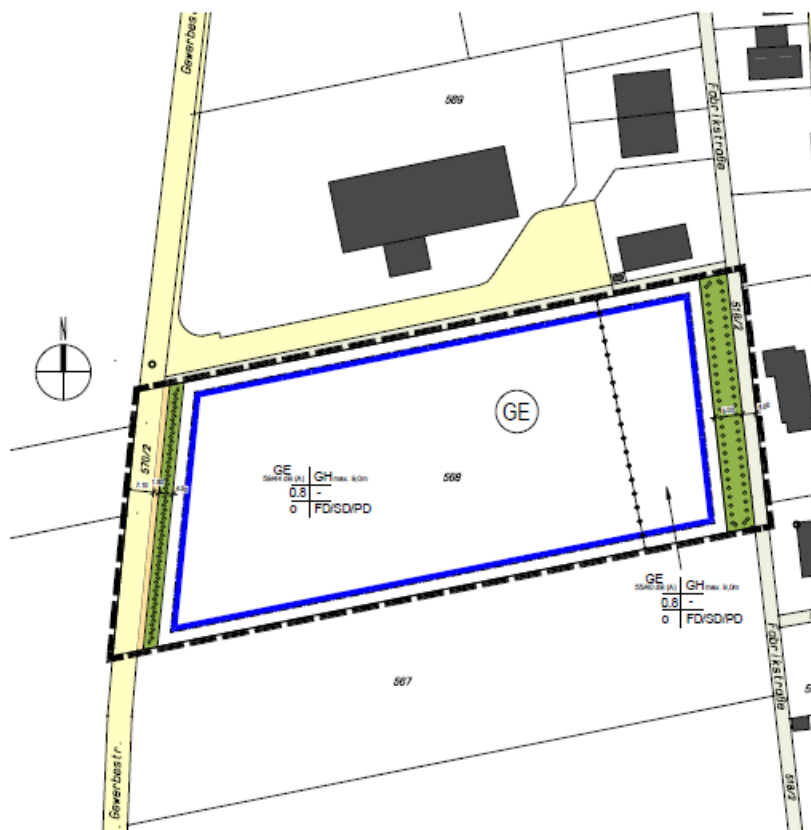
Lage der Baufläche und der Erweiterungsfläche (schwarze Umrandung)
